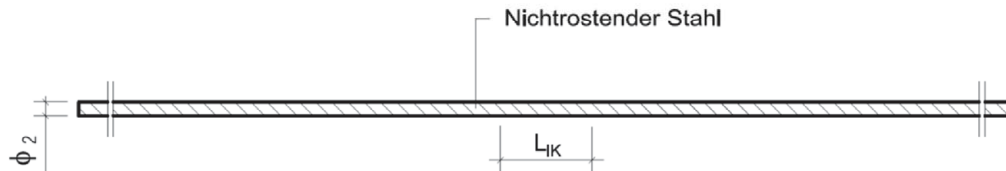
Zugstab aus nichtrostendem Betonstahl
